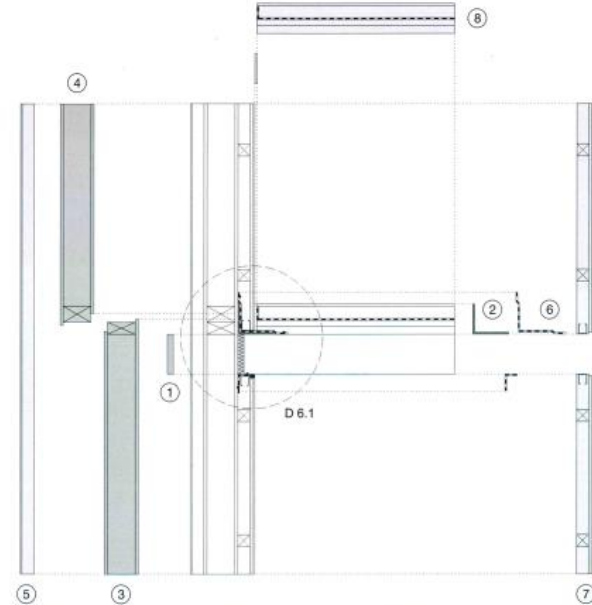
Montager Reihenfolge - Anschluss Geschossdecke - Außenwand, vorgestellt
